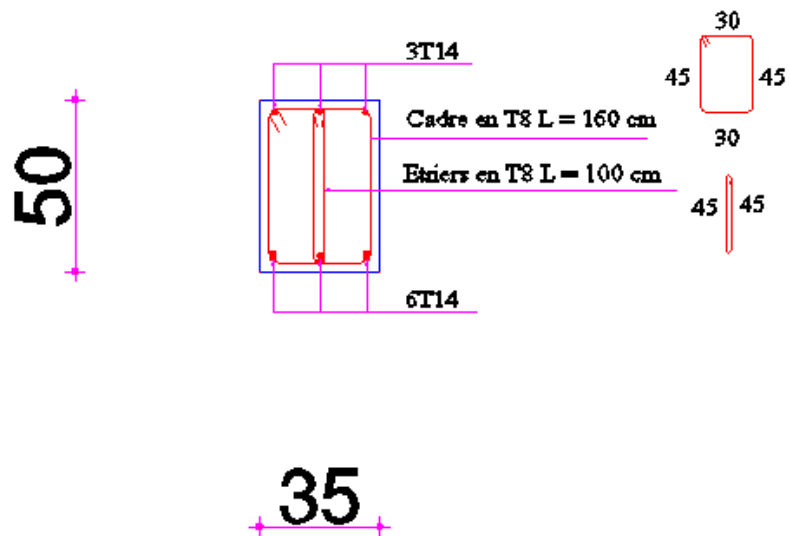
ferrailages des poutres principales en travée (35x50)
